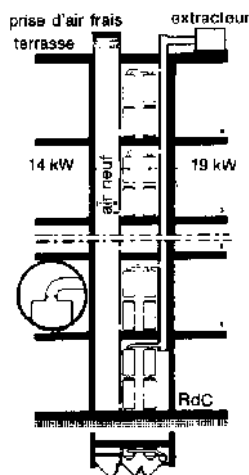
Installation de chauffage central dans un immeuble par A.T.G. fonctionnant en tirage mécanique.
